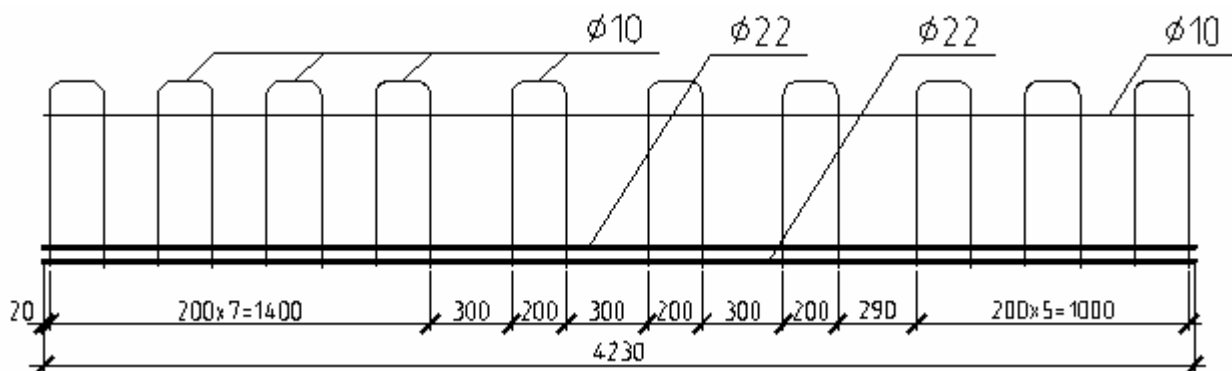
Схема армирования ригеля НР 1–6.
